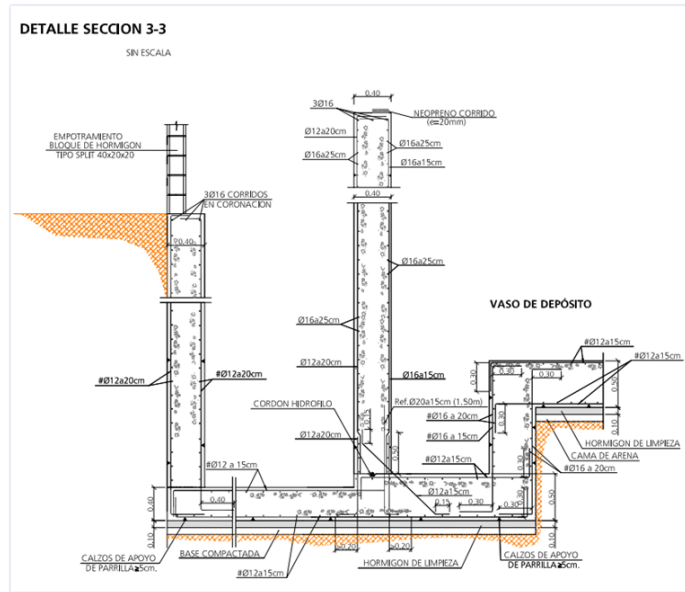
Detalle de arranque de muros perimetrales y solera: muro de cámara de llaves
